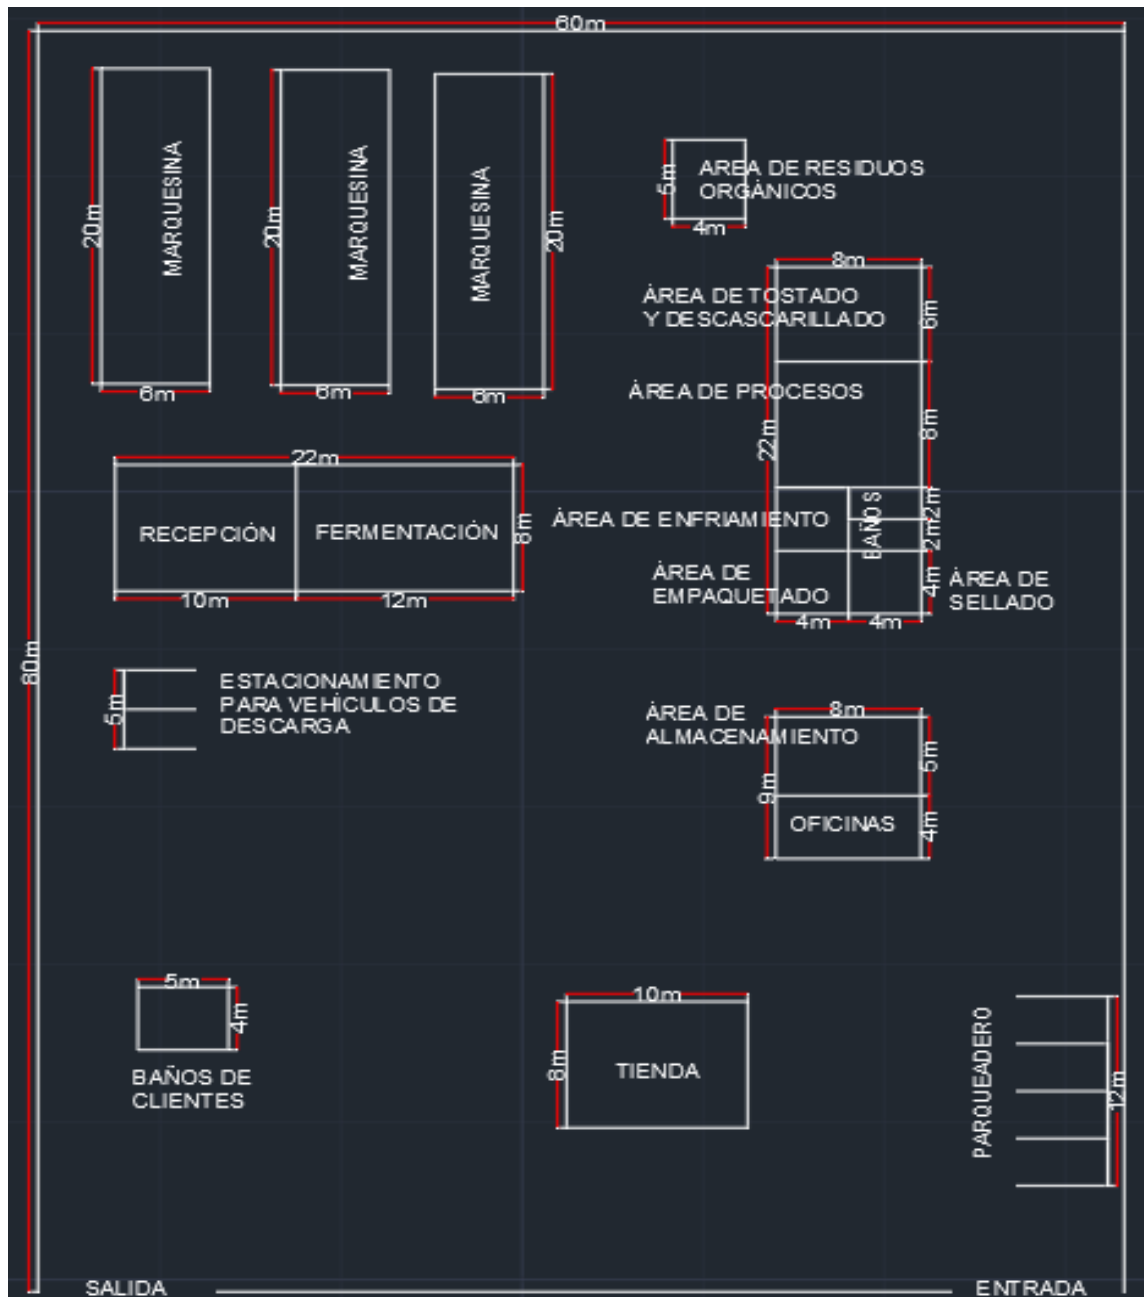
Diseño de planta propuesto de toda la fábrica
